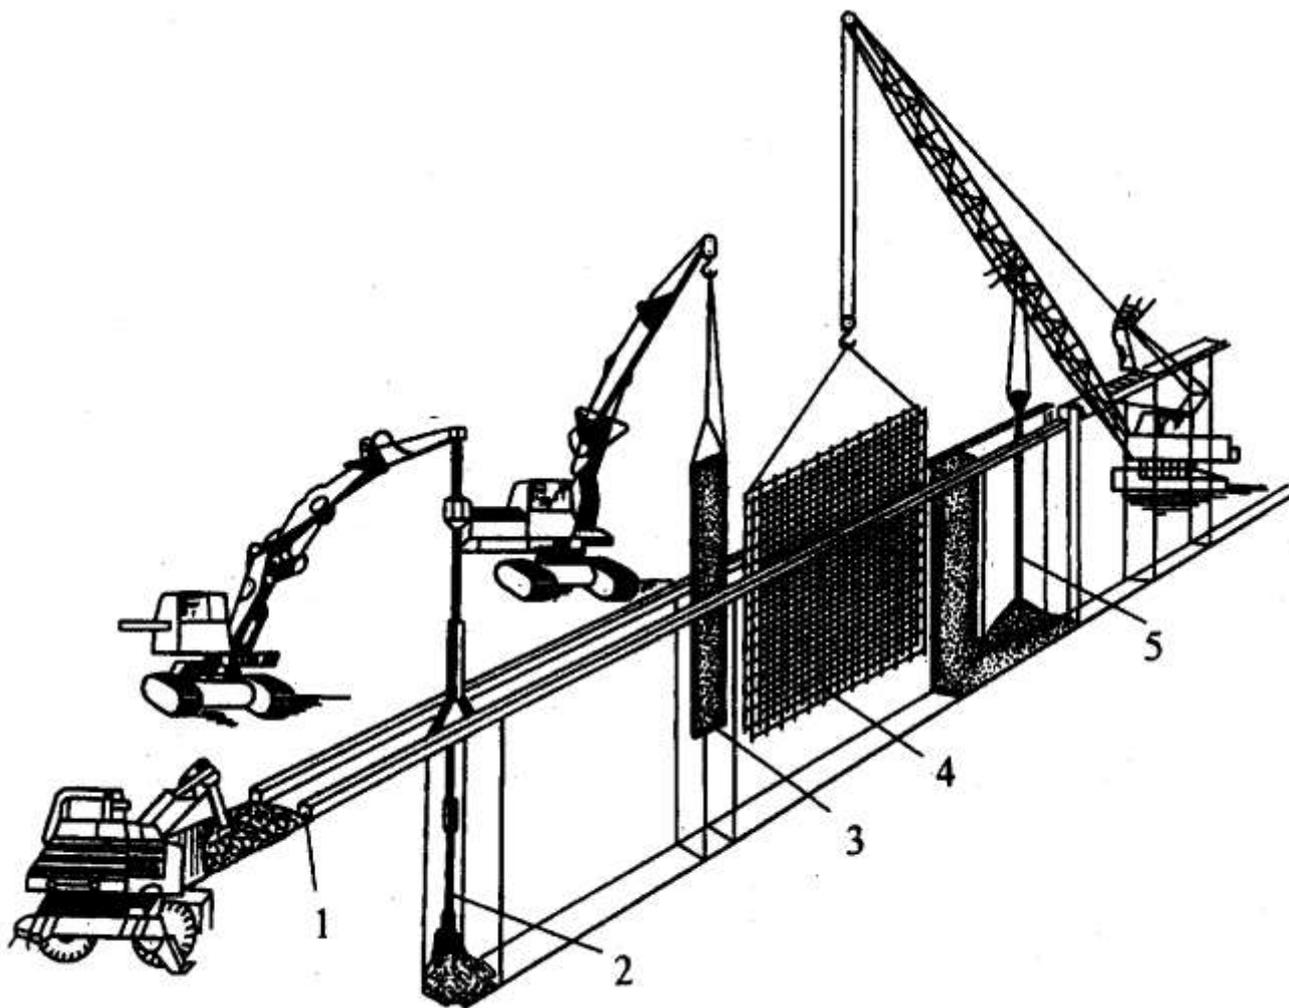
Технологическая схема устройства монолитной стены в грунте:
